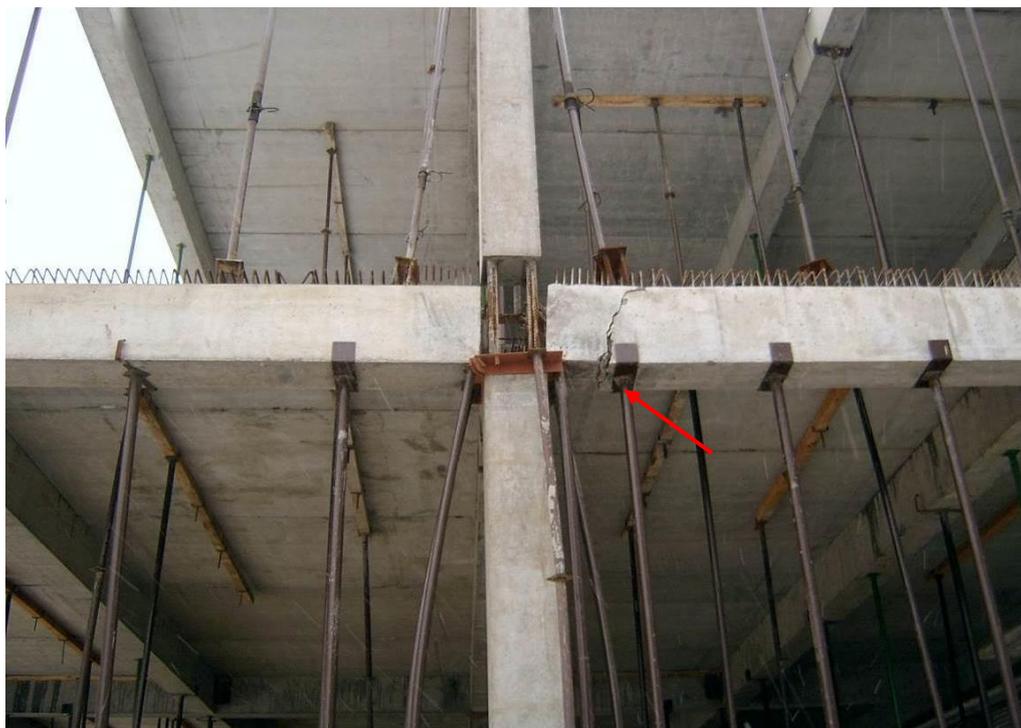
Фрагмент перекрытия над первым этажом. Сквозная трещина в основном ригеле в зоне сопряжения с колонной шириной раскрытия до 5 мм.
